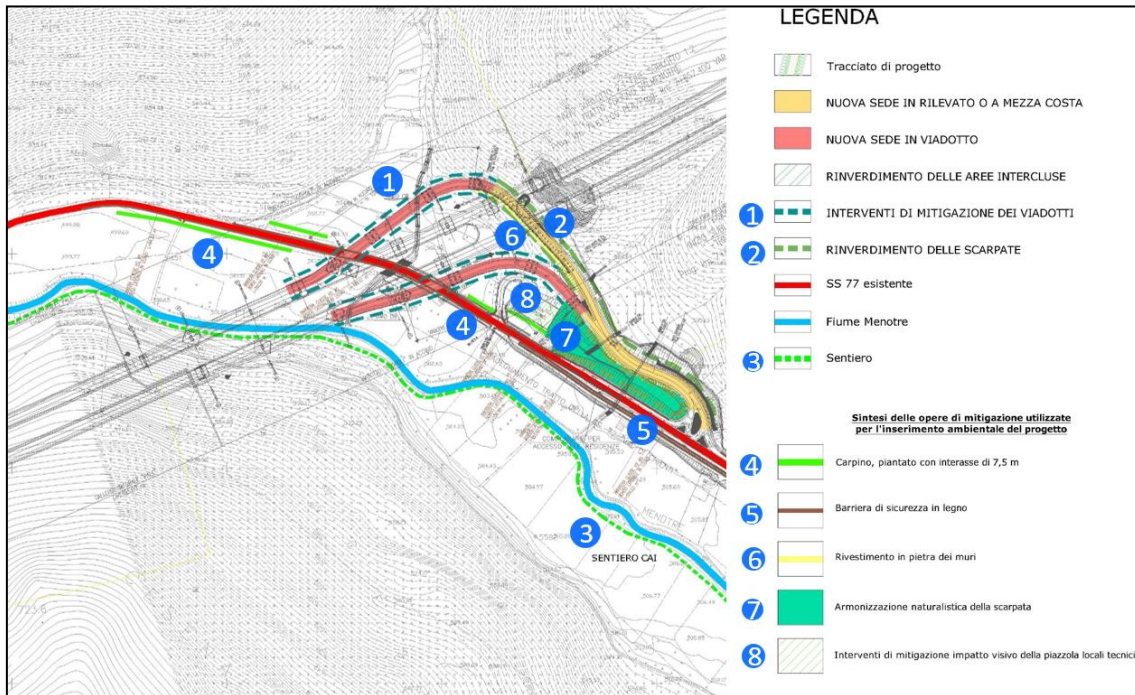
Semisvincolo di Val Menotre, planimetria di progetto “Compatta” con interventi di mitigazione
